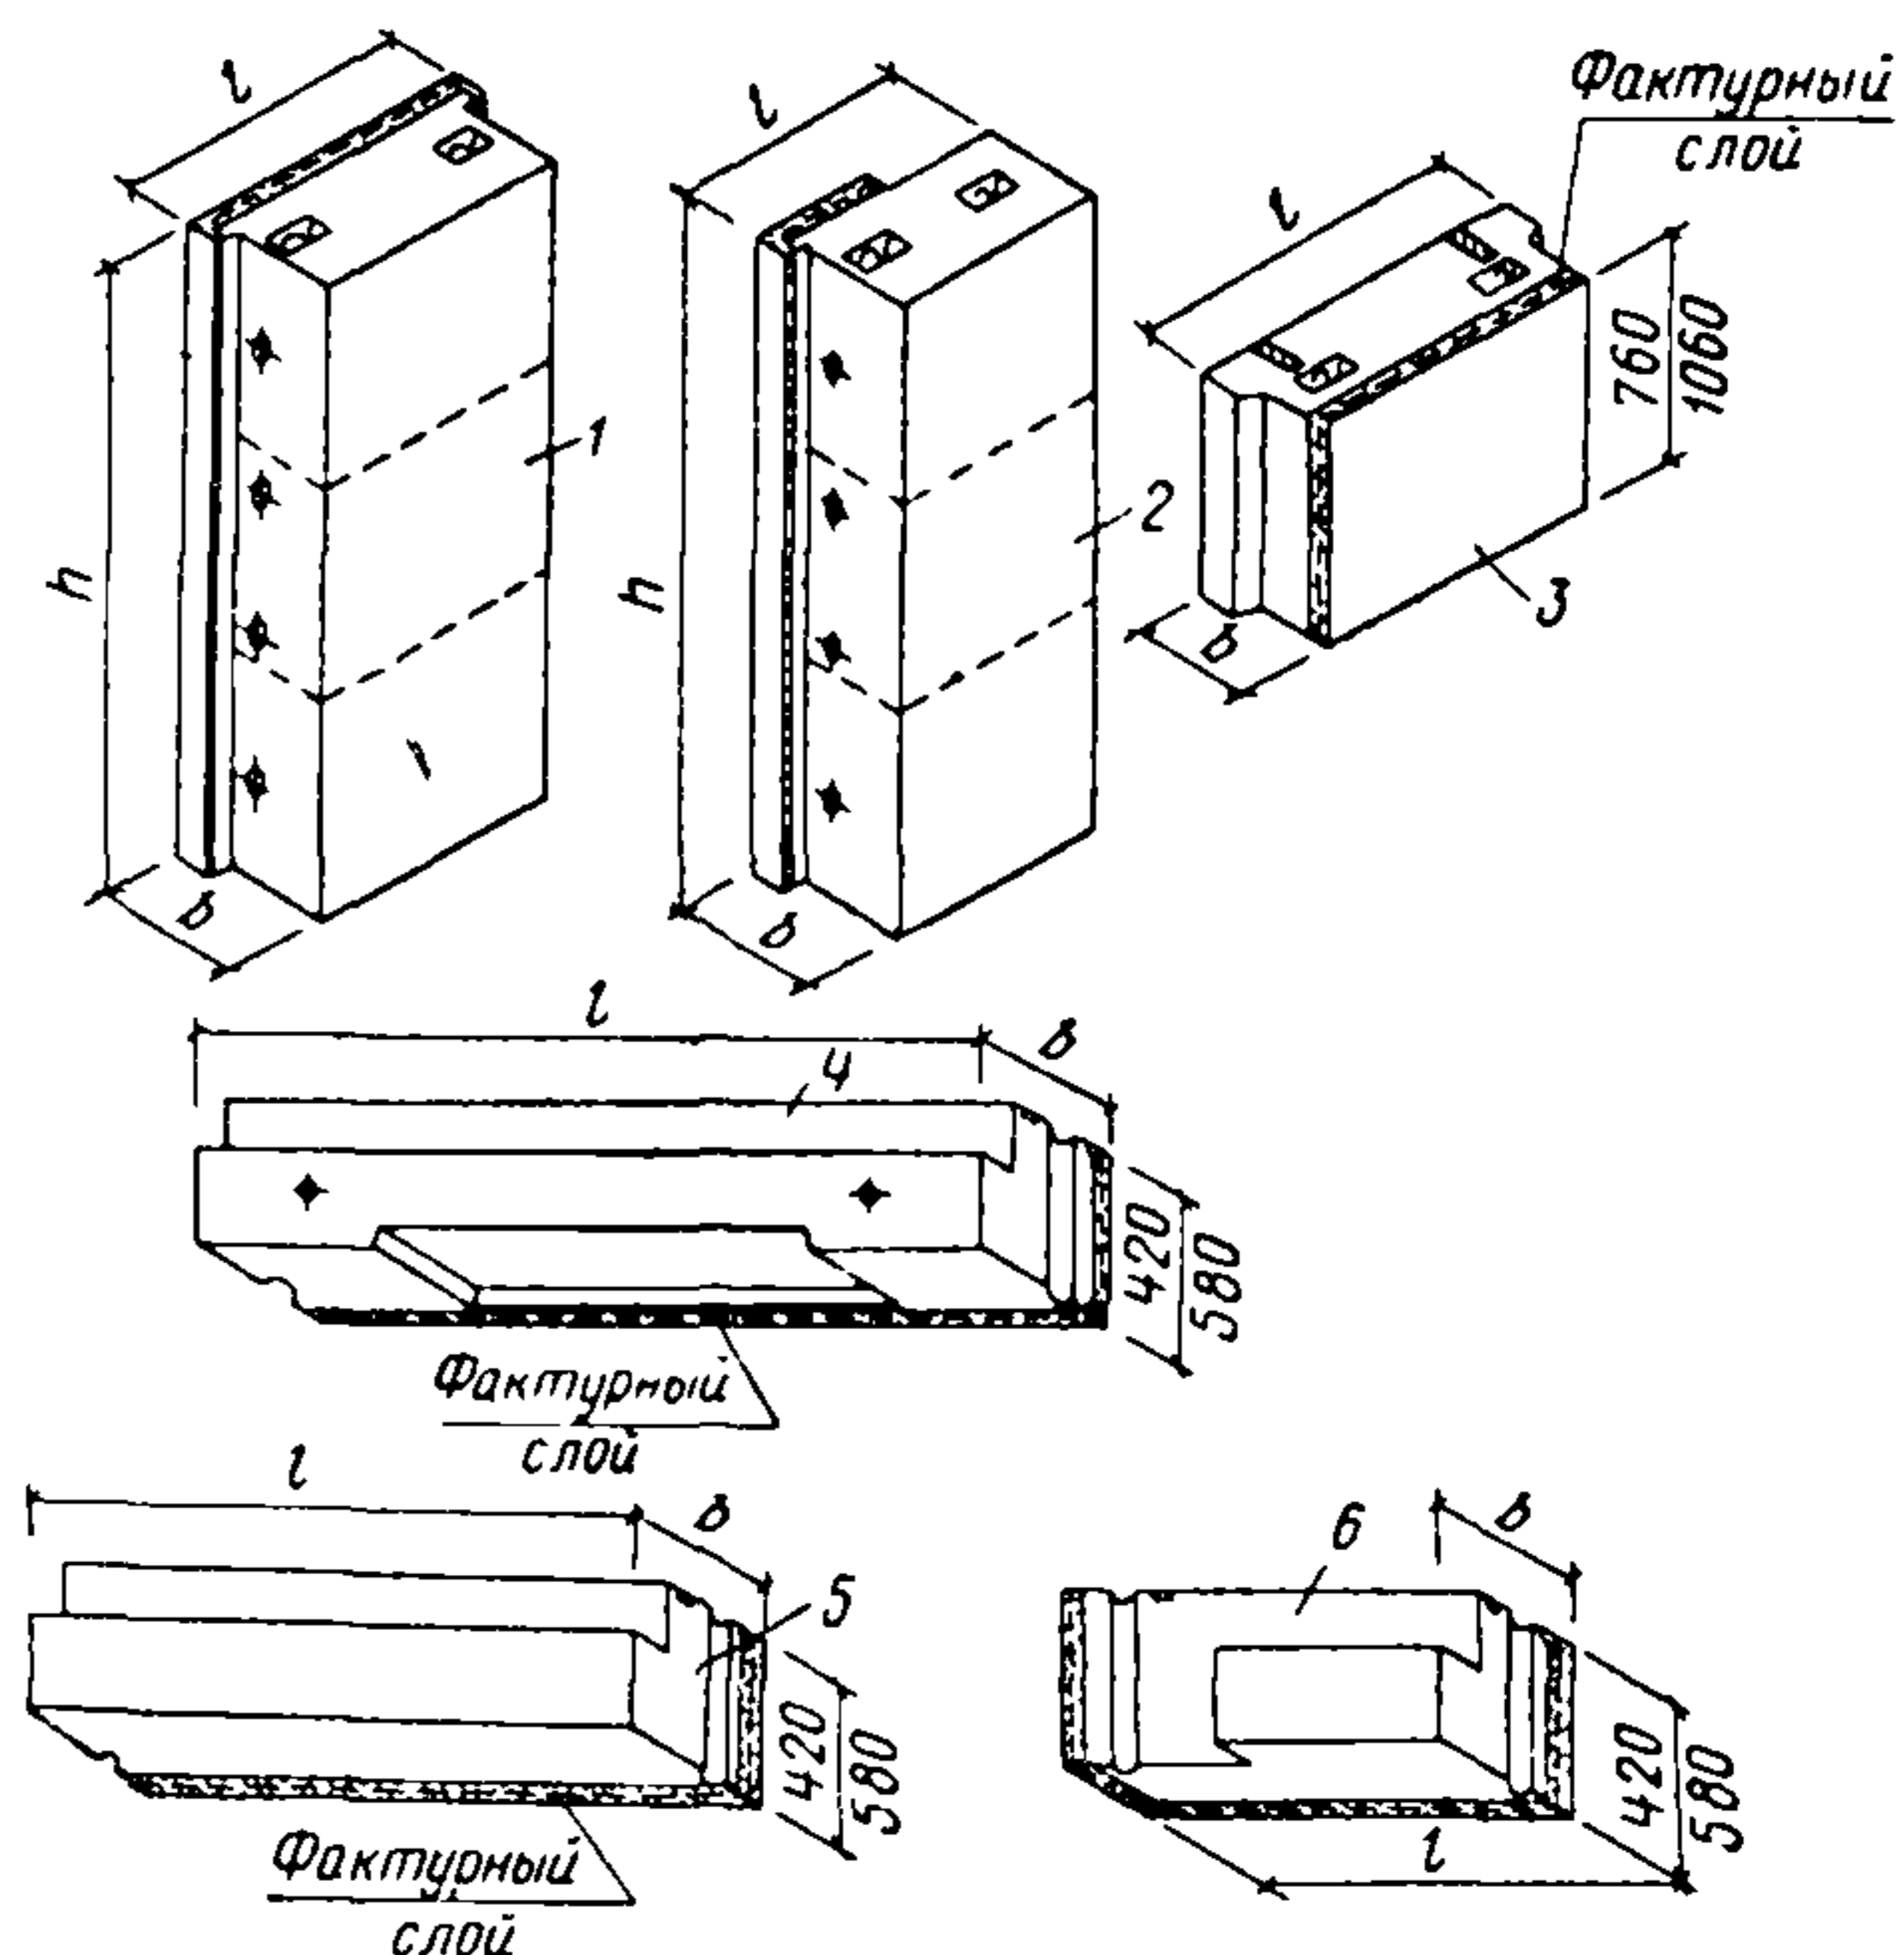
Основные типы крупных блоков наружных стен для жилых зданий
